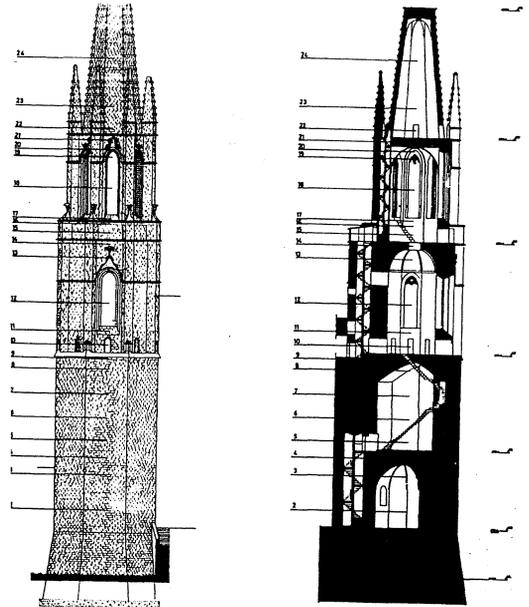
Alzado NW y sección con todas las secciones realizadas para el análisis estructural
